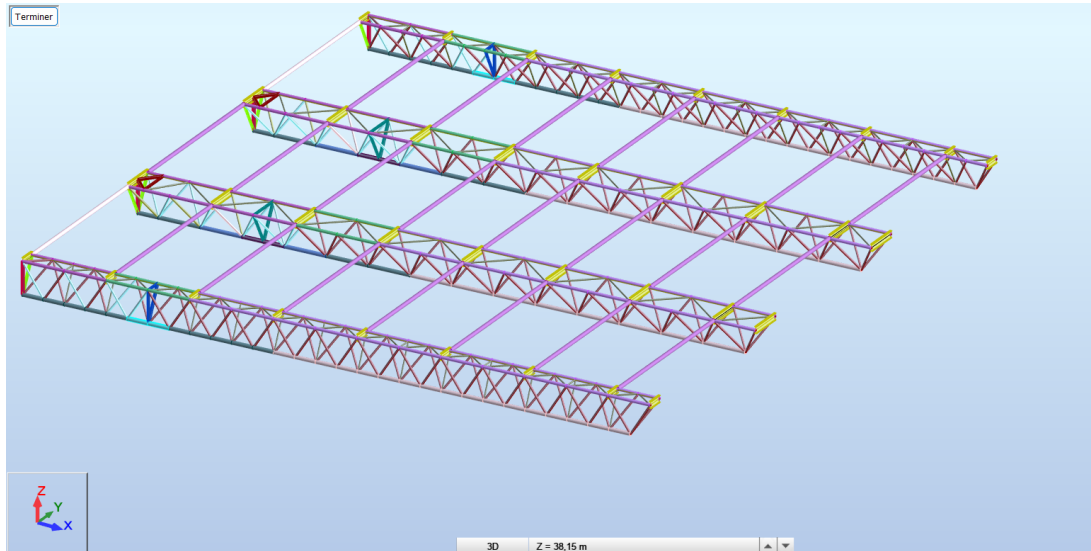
Vue 3D de la toiture illustrant la disposition des poutres principales
